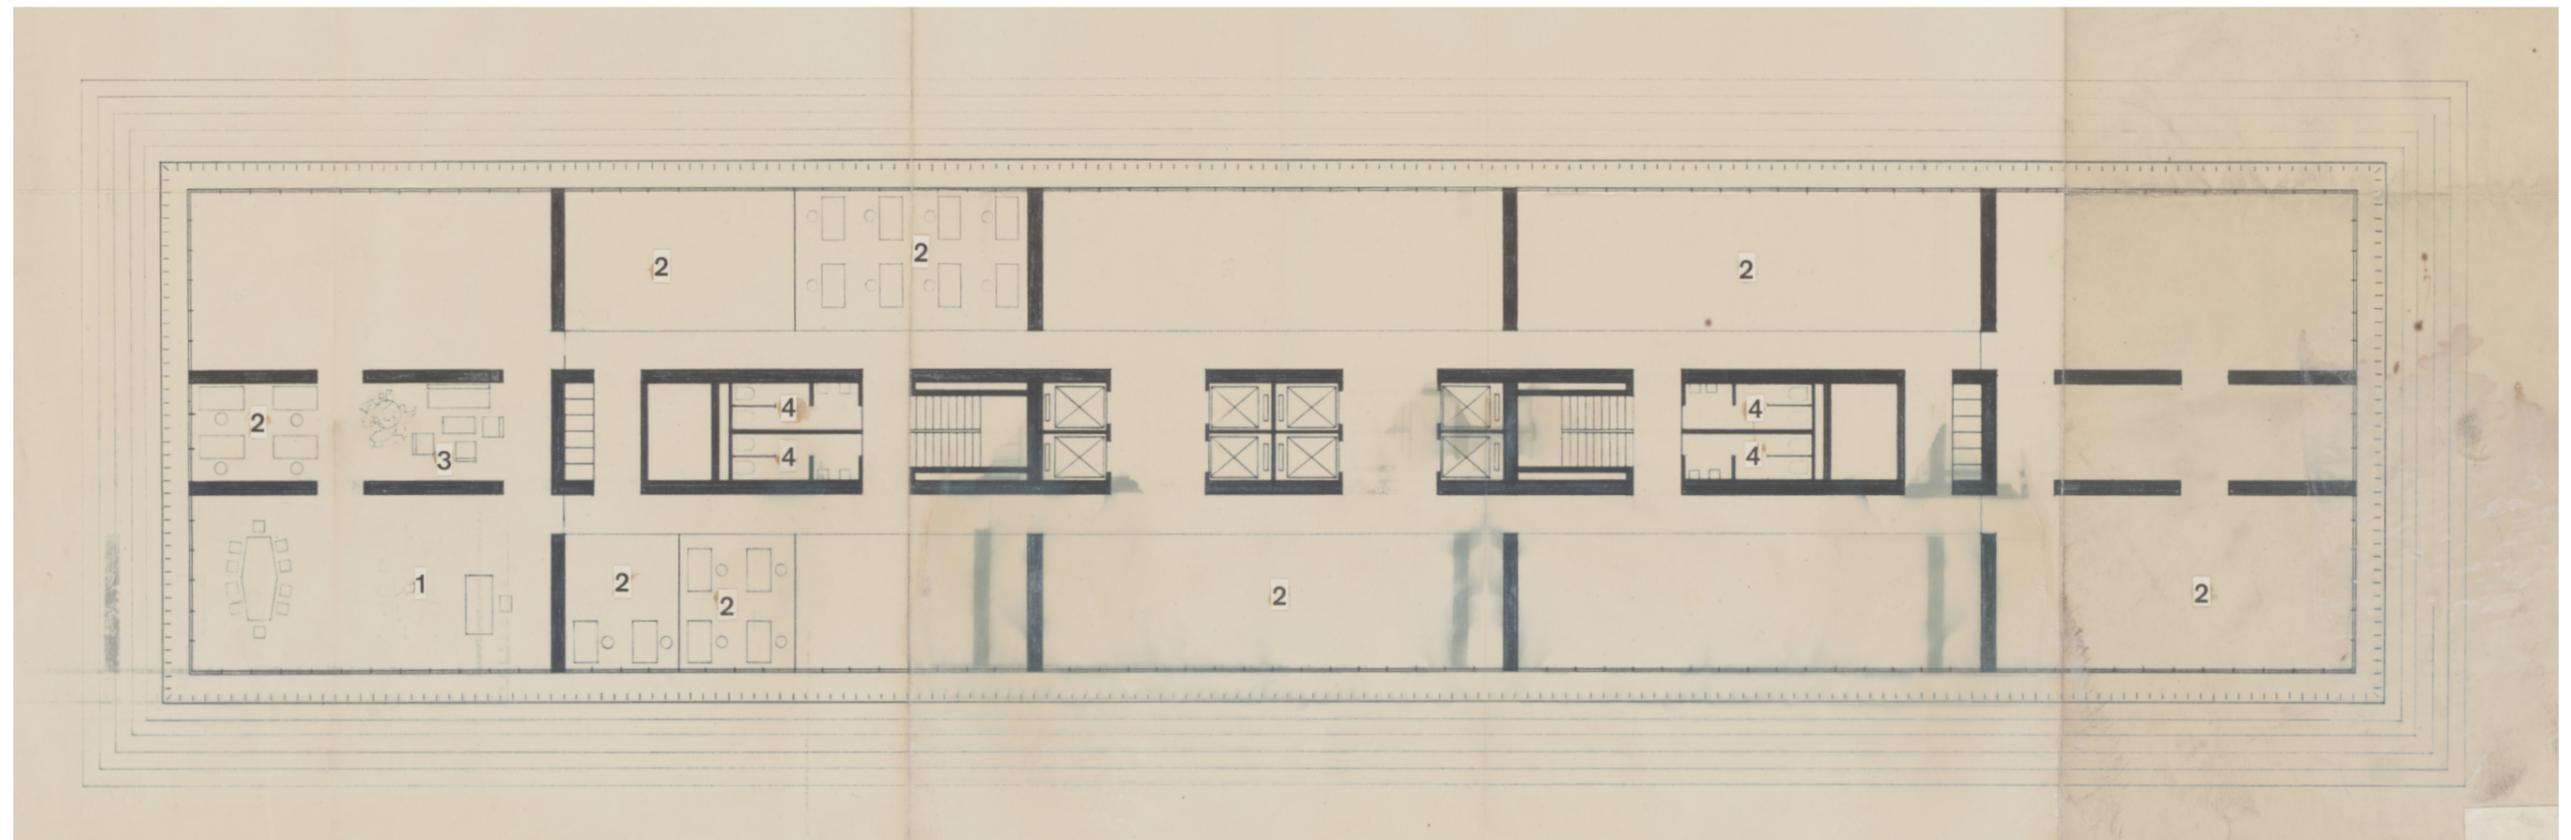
Grundriss (Bürogeschosse) mit Raumkategorisierungen, 1:100, undatiert
